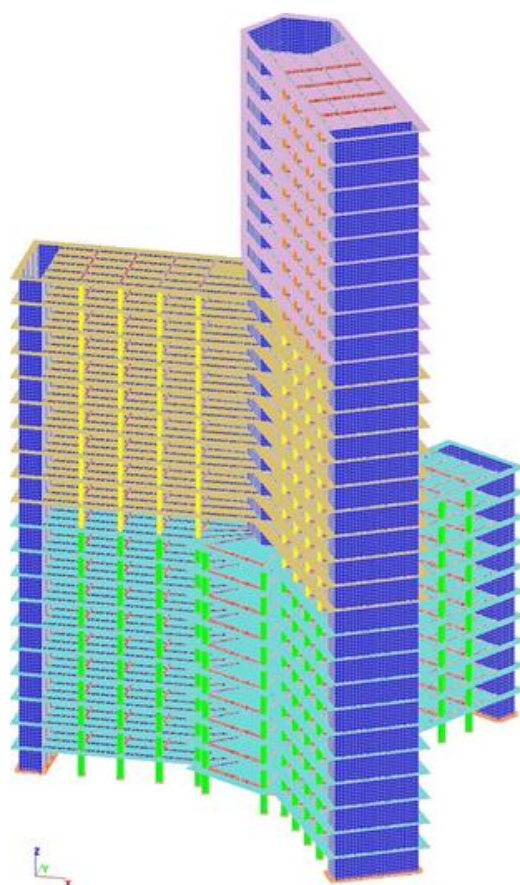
Розрахункова схема будівлі в ПК SCAD
